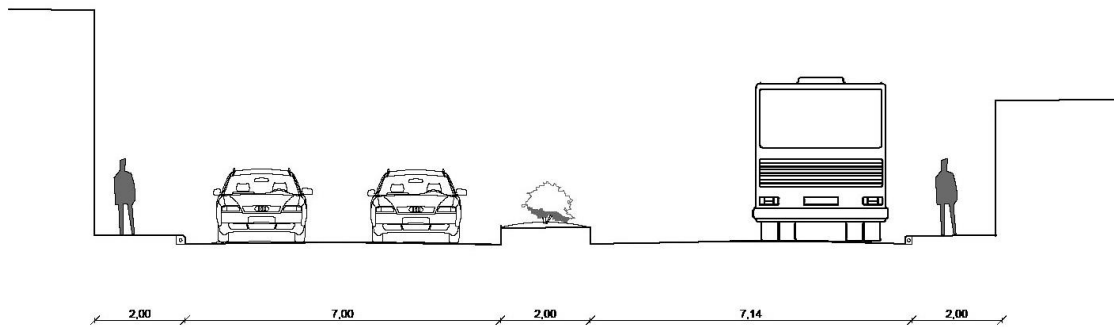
Perfil vial propuesto Carrera 11 tramo Zona rosa alta
